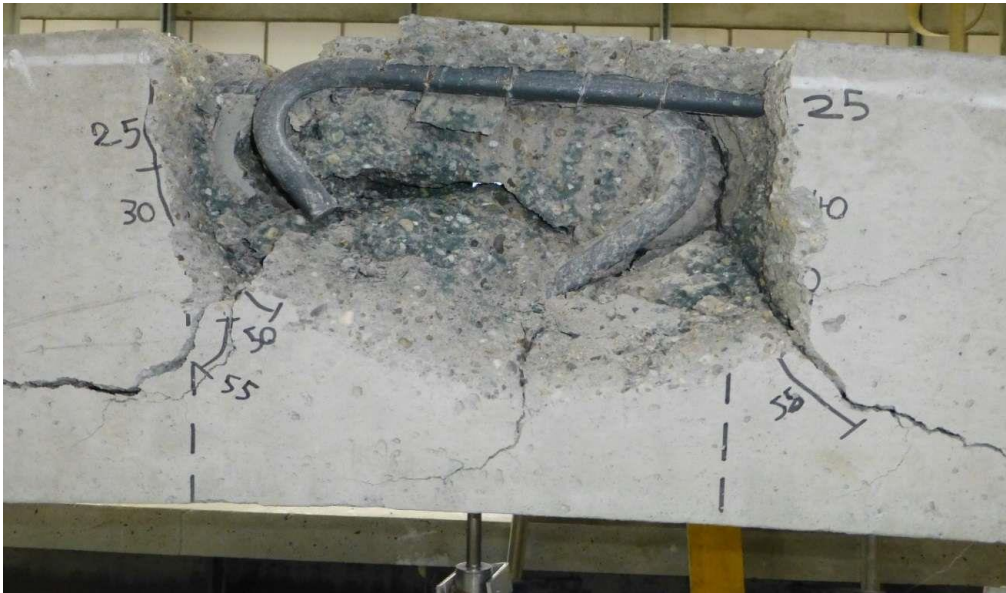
Seitenansicht Balken mit Stoß Typ II und muschelförmigem Betonausbruch
